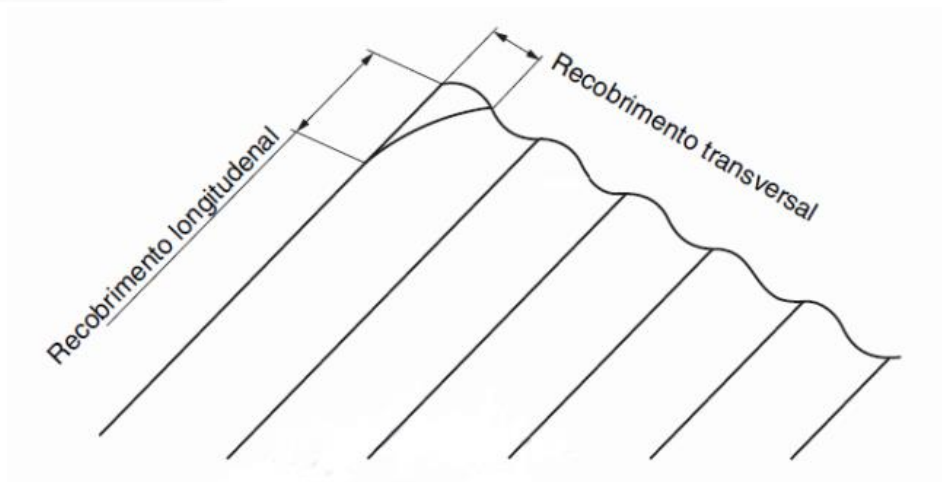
Esquema de recorte de canto para telhas onduladas Fonte: Adaptado
